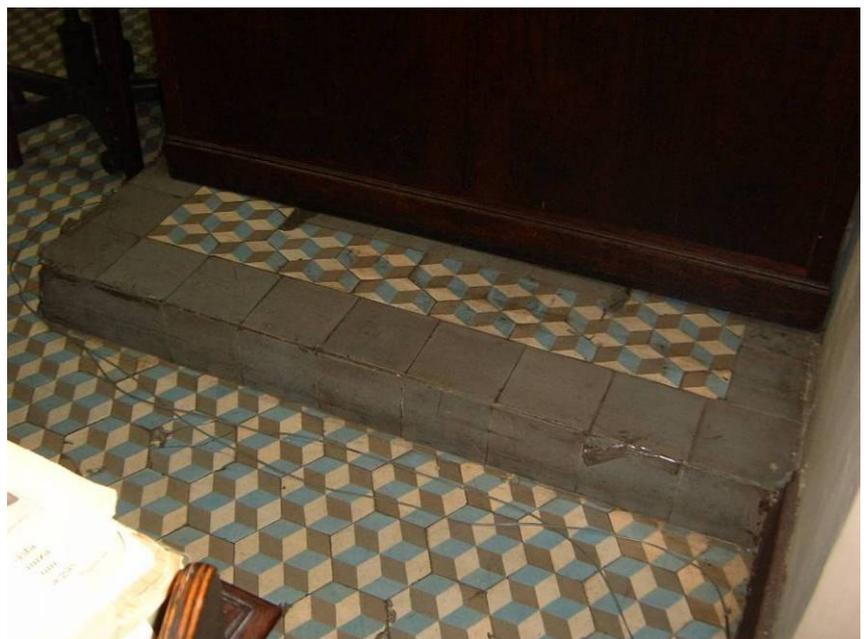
Detalhe de trecho do piso em ladrilho (pavimento de acesso da Avenida Rio Branco, salão voltado para a Rua Pedro Lessa). Fotografia da autora.
